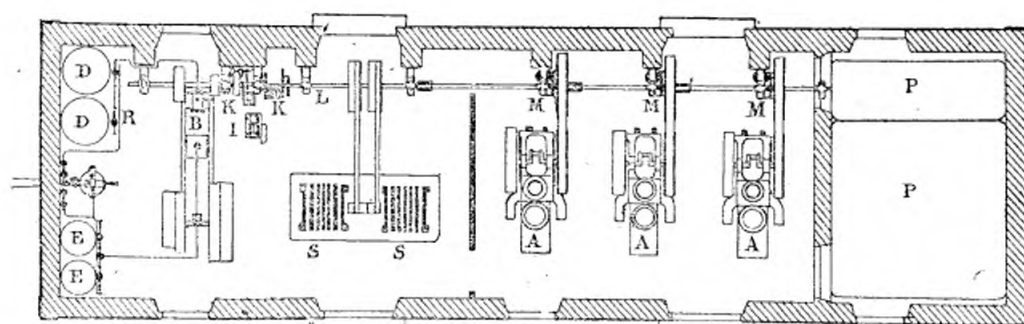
Installation de la machine du phare de Belle-Isle.
